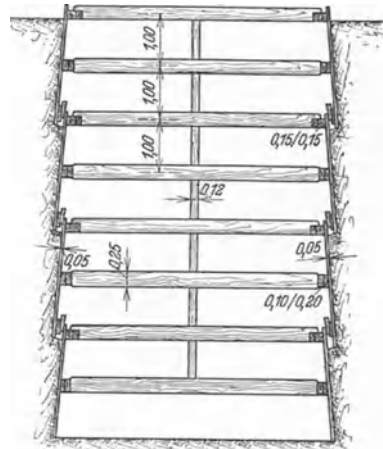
Baugrubenaussteifung mit vertikalen Dielen.
